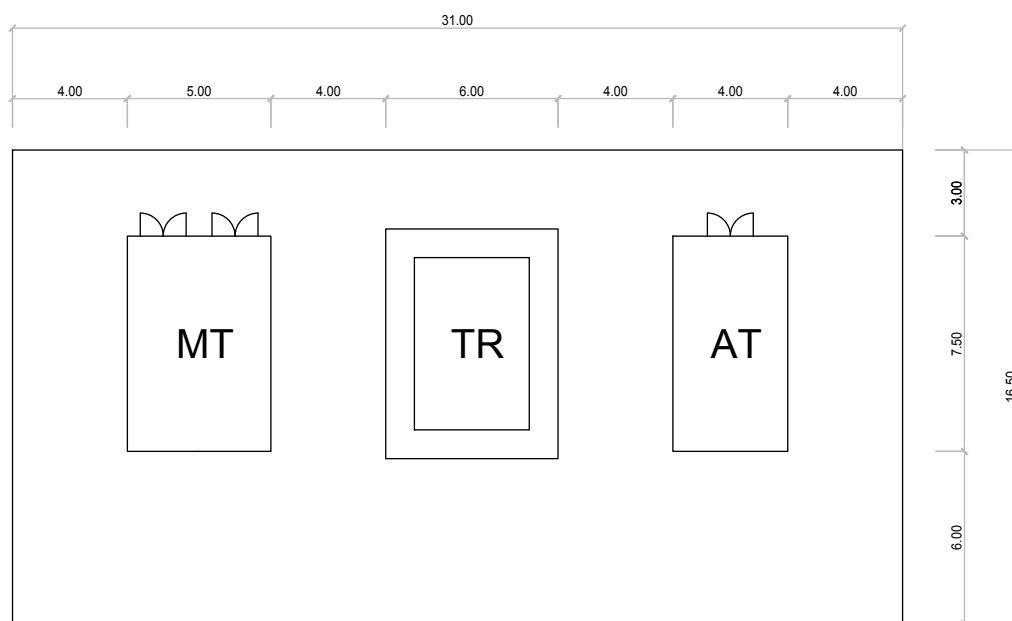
Platea di fondazione dell'area di trasformazione e disposizione cabine.
